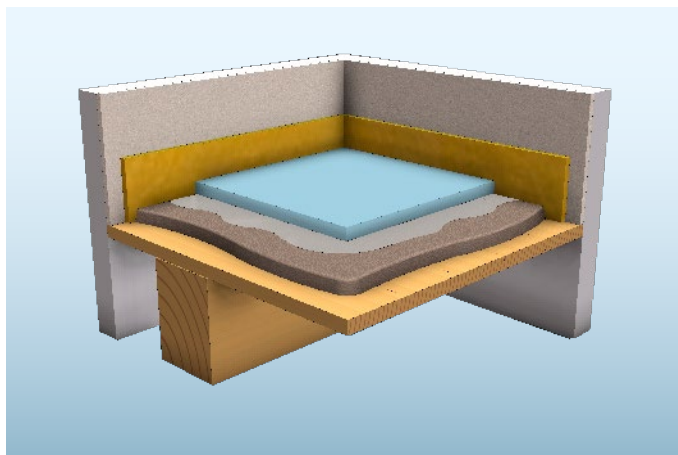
Estrich auf Holzbalkendecke mit EPO-Leicht
